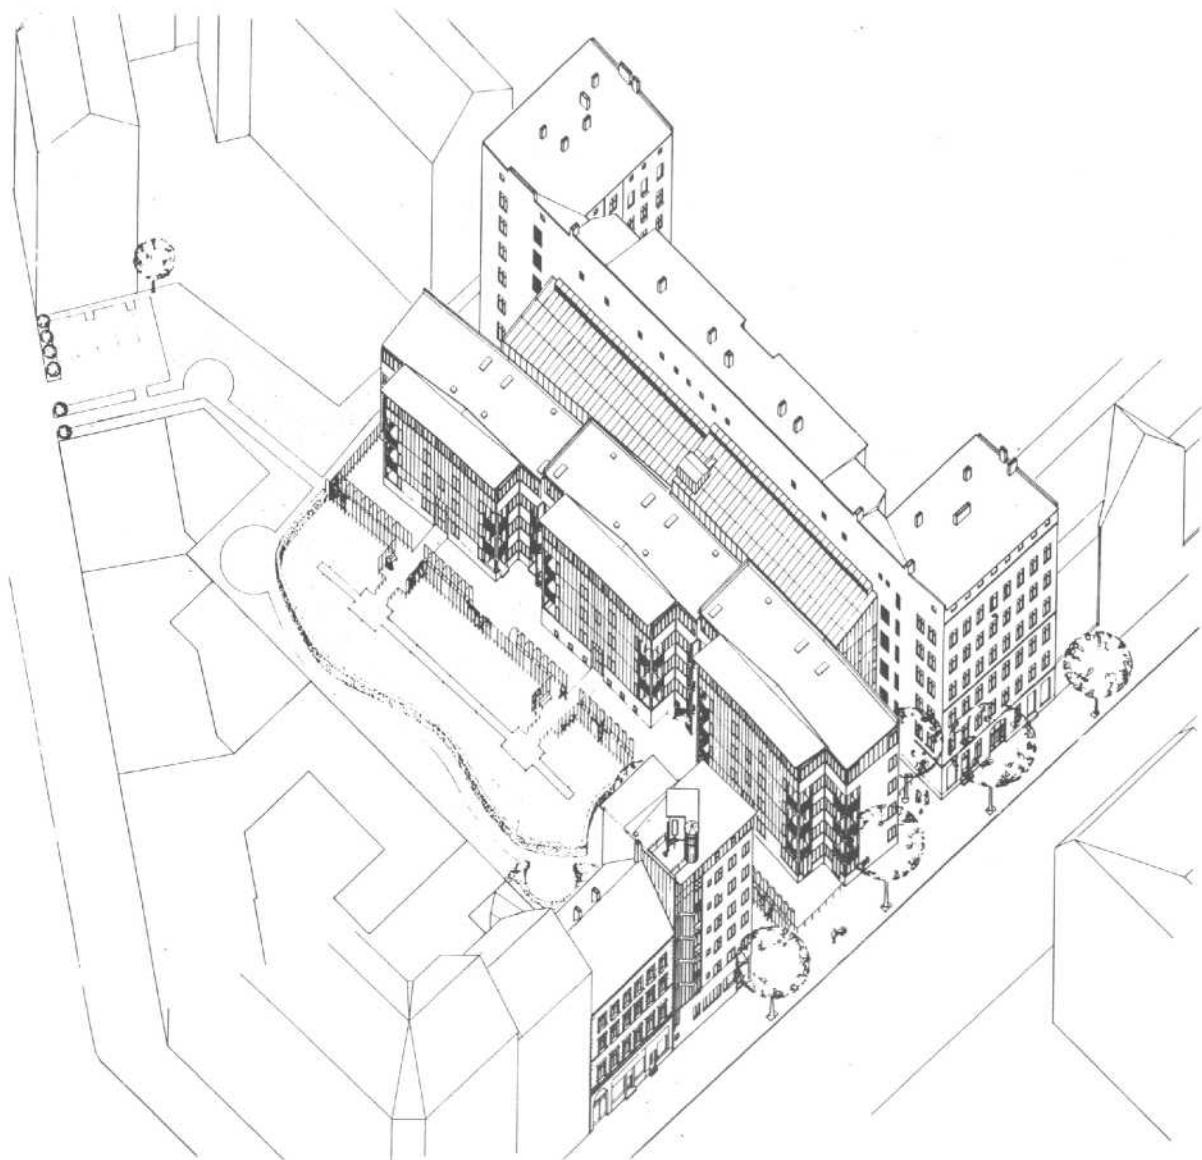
Residencia para ancianos Köpenicker Straße (arquitecto Otto Steidle, Berlin/Munich).
